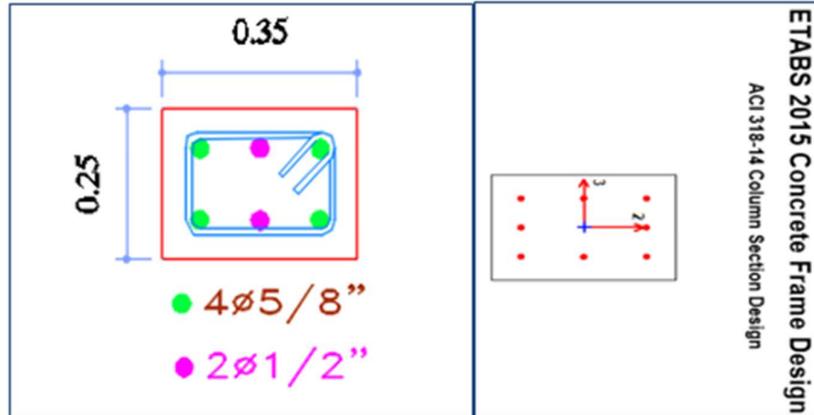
ETABS, Sección de Columna "Rec." 25cm x 35cm.
